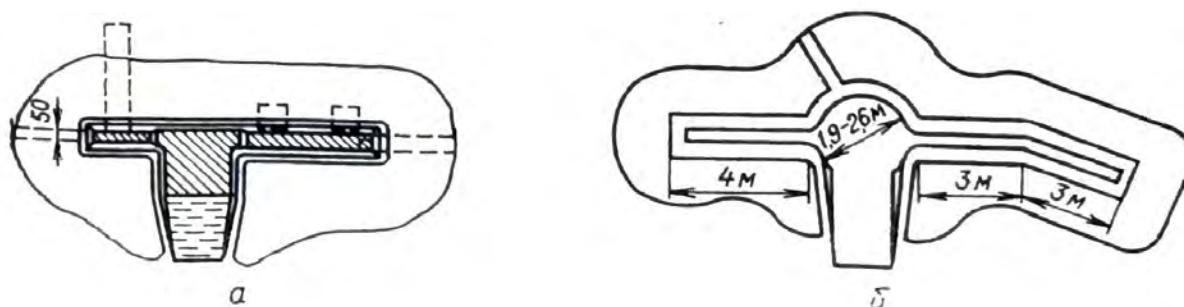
Окопы для 85-, 100-мм минометов с прямоугольными очертаниями в плане (а) и круглой площадкой (б)
